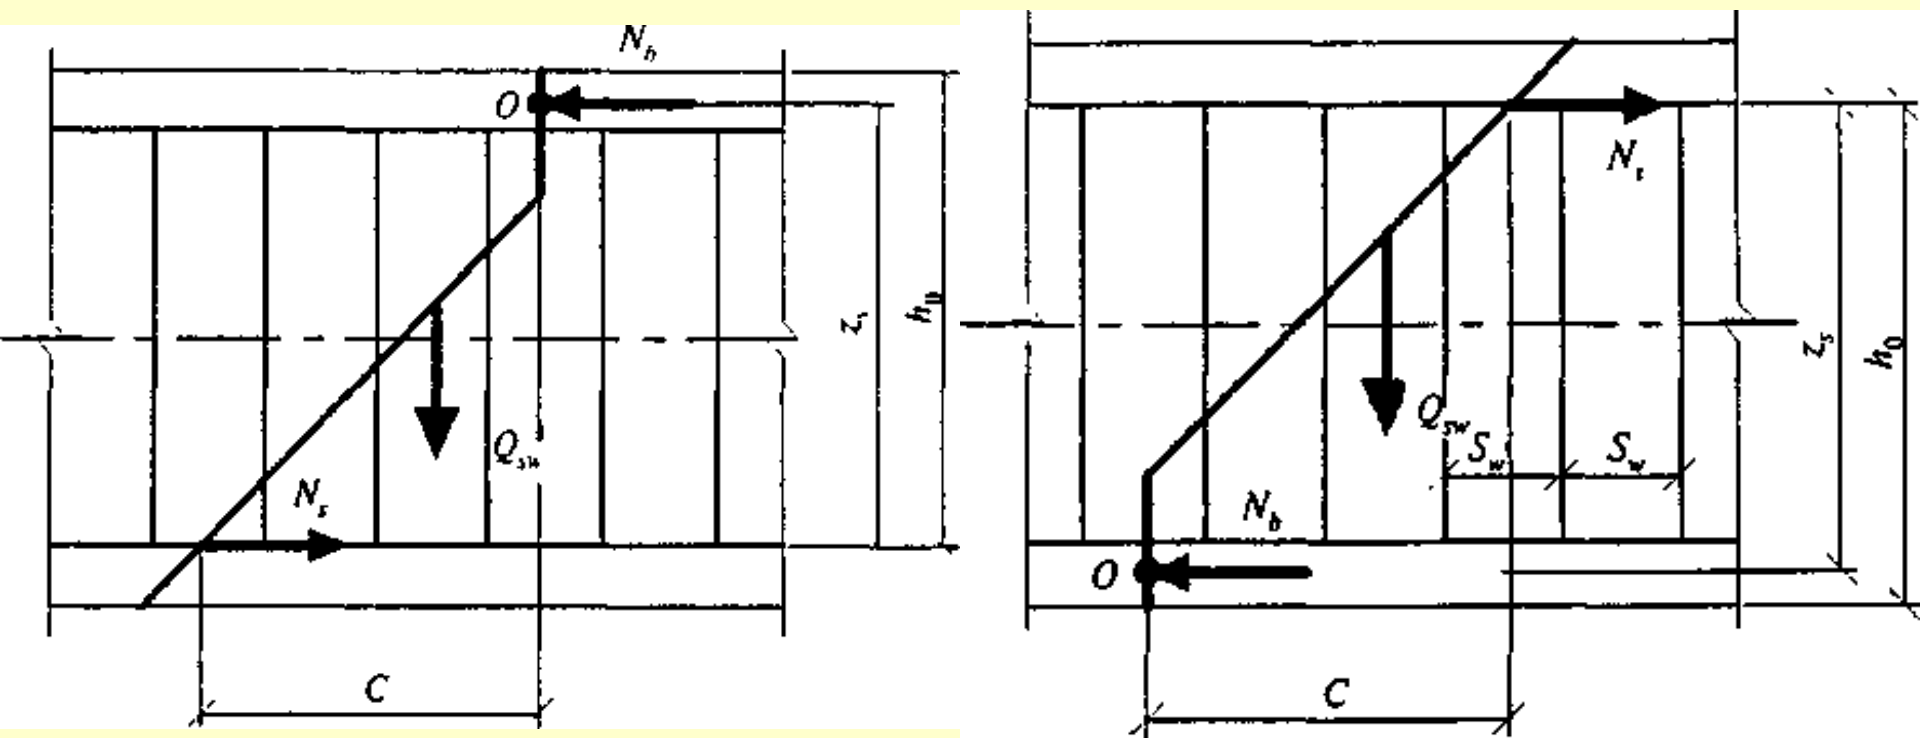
Схема усилий при расчете железобетонных элементов по наклонному сечению на действие моментов
